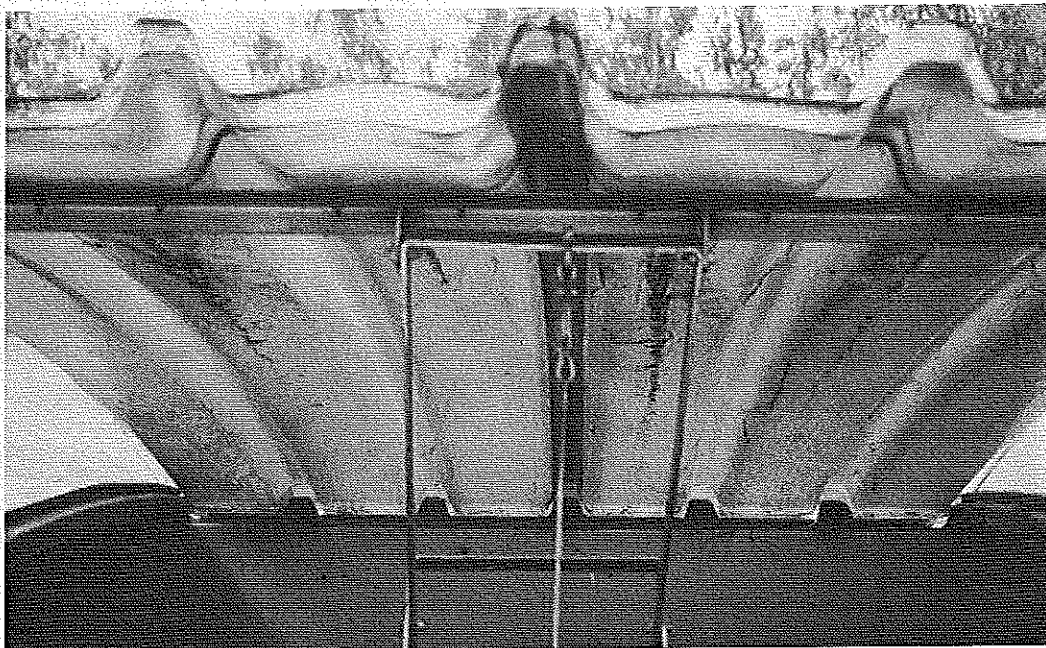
Aspect sous-face d'un panneau ouvrant. © J. Putatti
